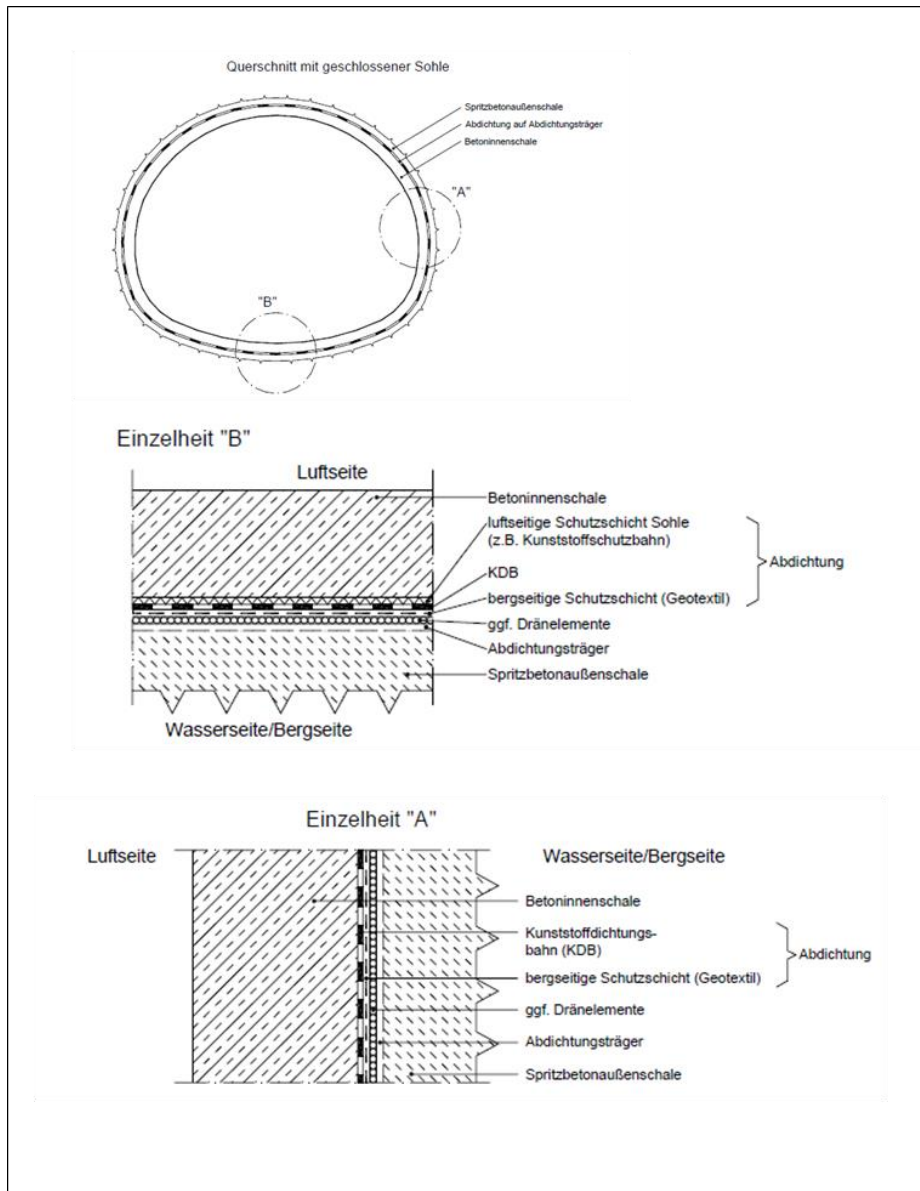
Ausführungsbeispiel Standardraum Abdichtung Tunnel in geschlossener Bauweise<sup>429</sup>
